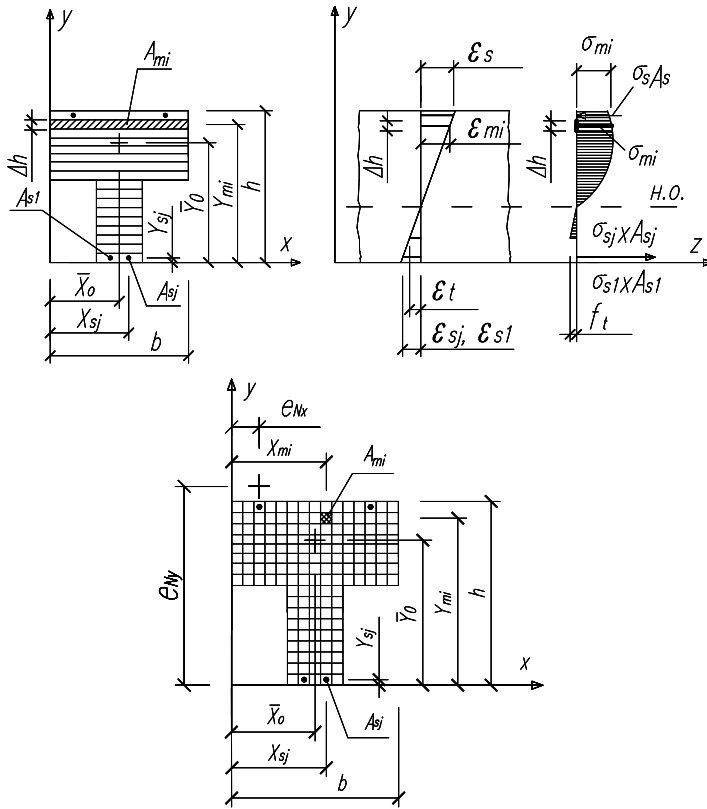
Расчетная схема нормального к продольной оси сечения, разбиение на элементарные слои либо площадки
